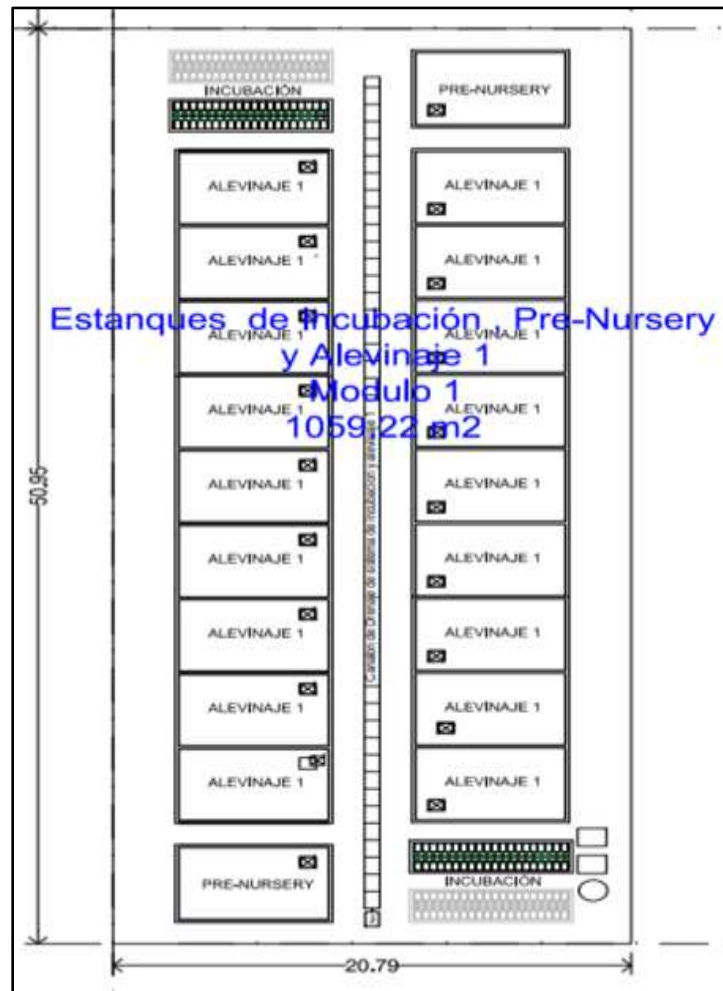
Dimensiones de las piletas de Alevinaje I, 2025.
